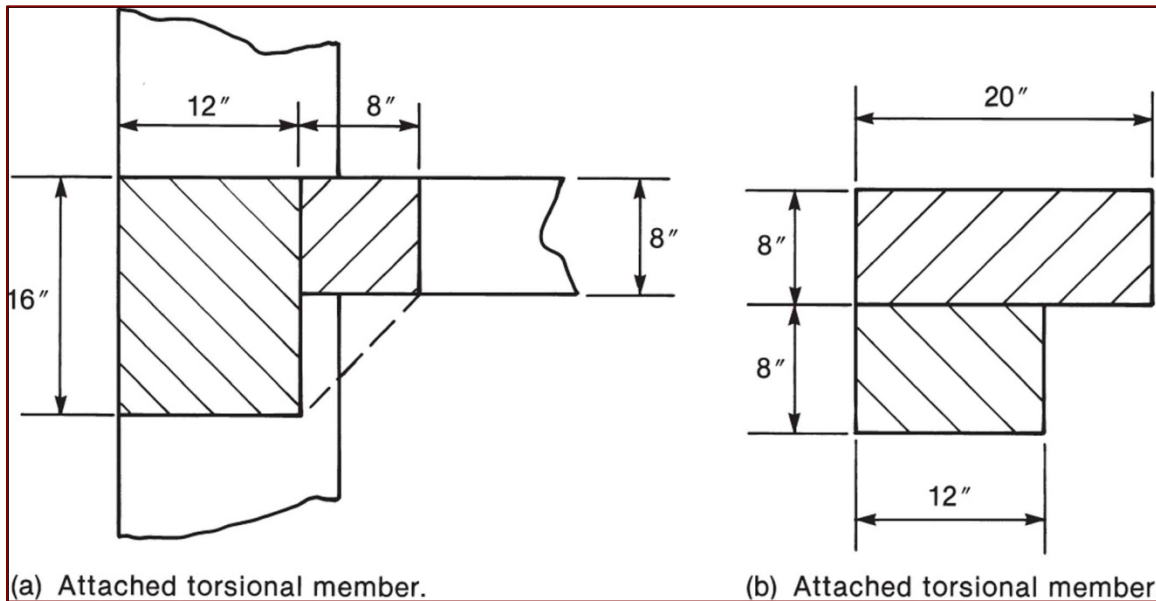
Losa, columna y viga de borde para Ejemplo 10-4.
